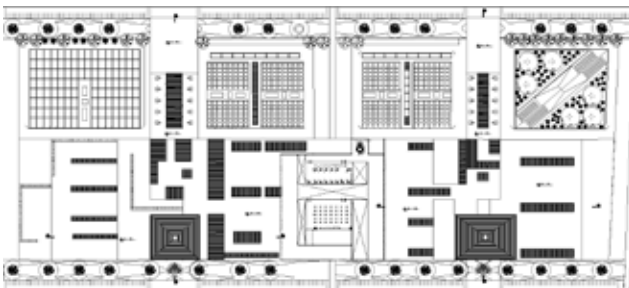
Planta Nivel 3. Fuente: Schaverin (2021)
